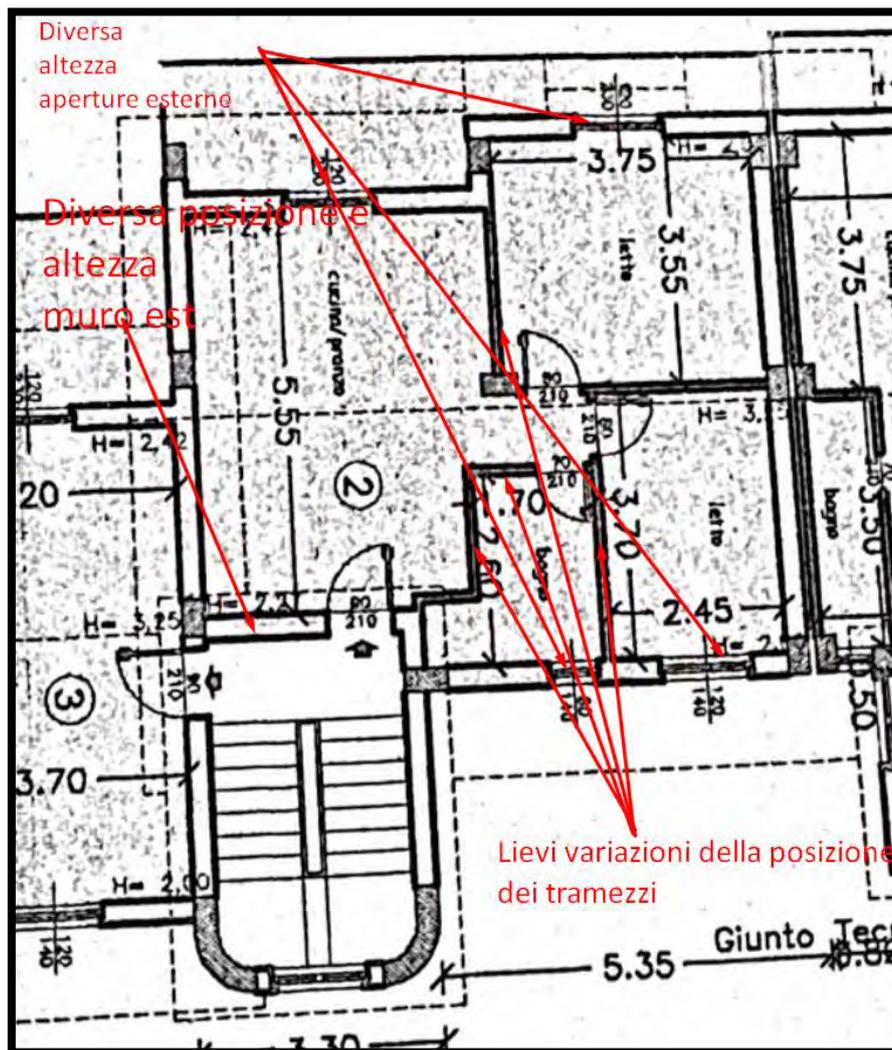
Pianta piano terzo allegata al Permesso a costruire n. 5 del 19/04/2011
